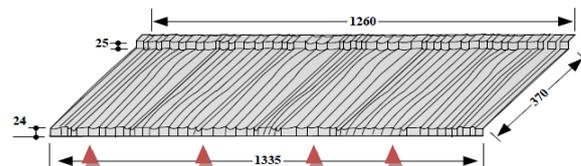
tuile METROTILE® MISTRAL - pose des fixations
